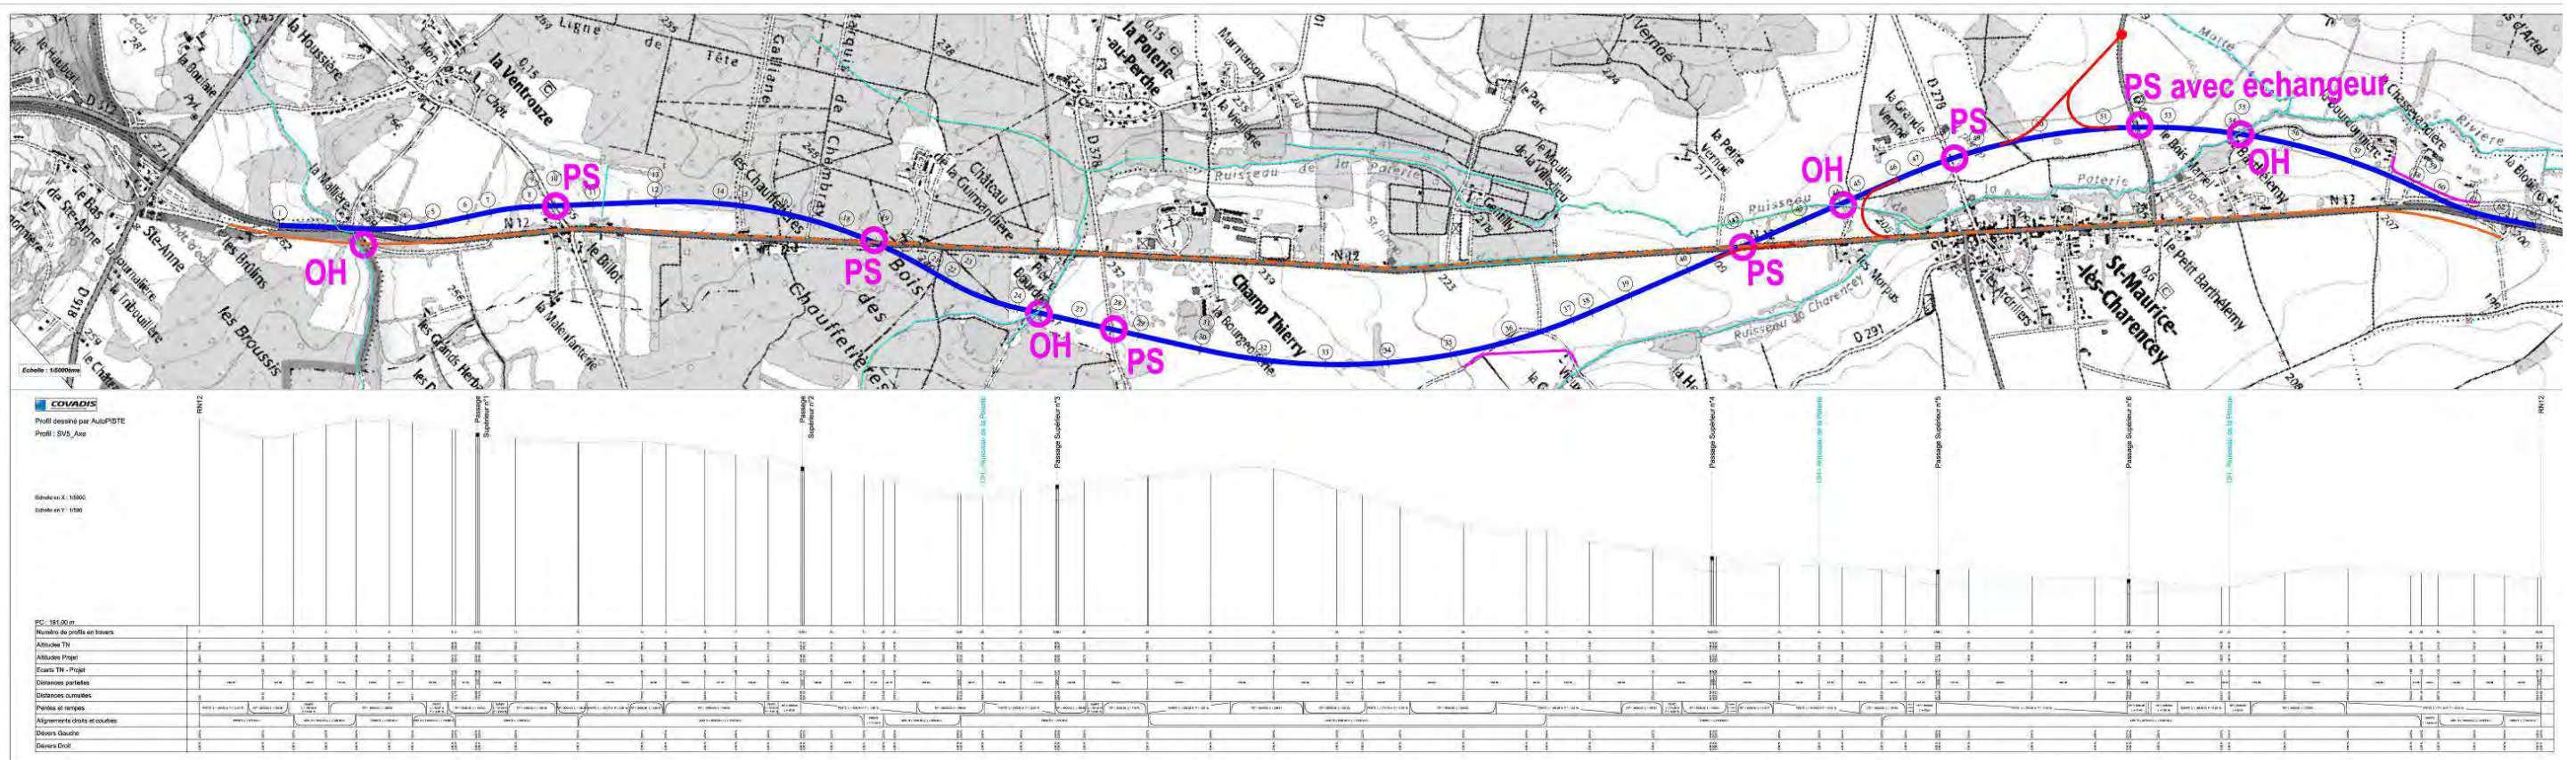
Tracé en plan et profil en long de la variante 5 (source : IGN / SEGIC)
